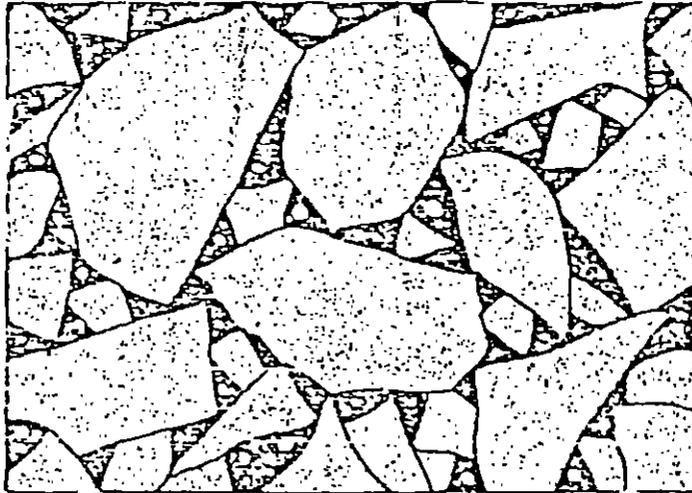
Esquema de la estructura formada por los áridos y el ligante asfáltico
